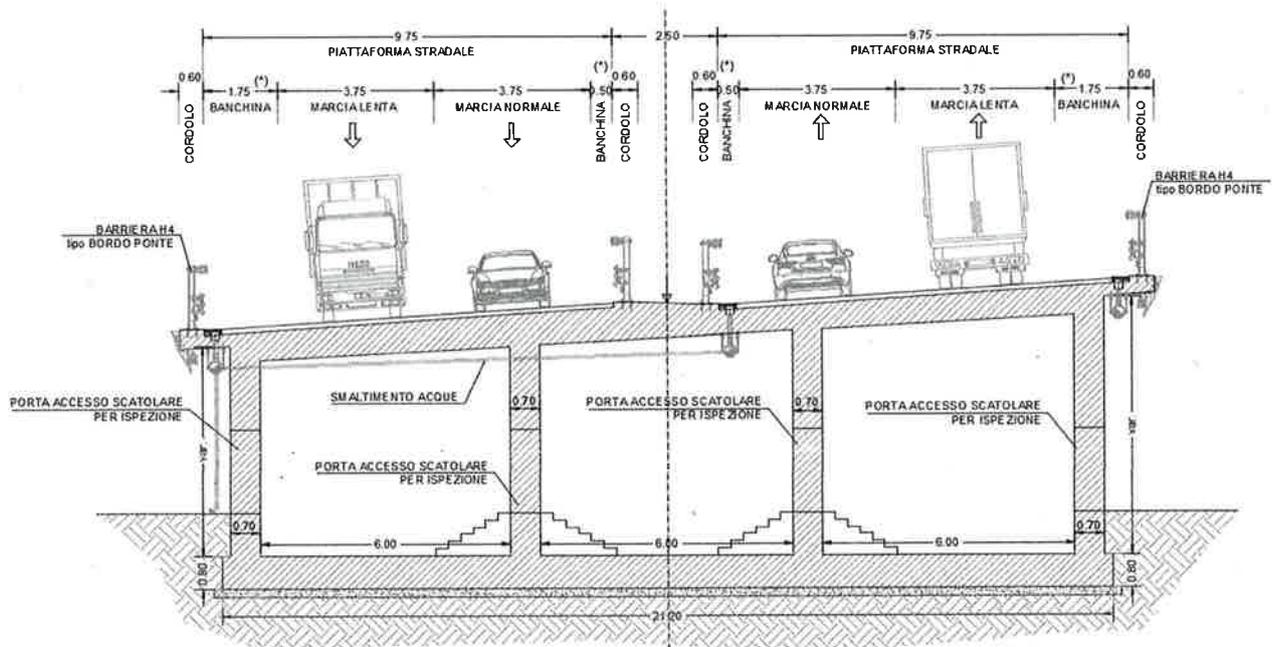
Sezione su rampa scatolare cavalcavia Serenissima
